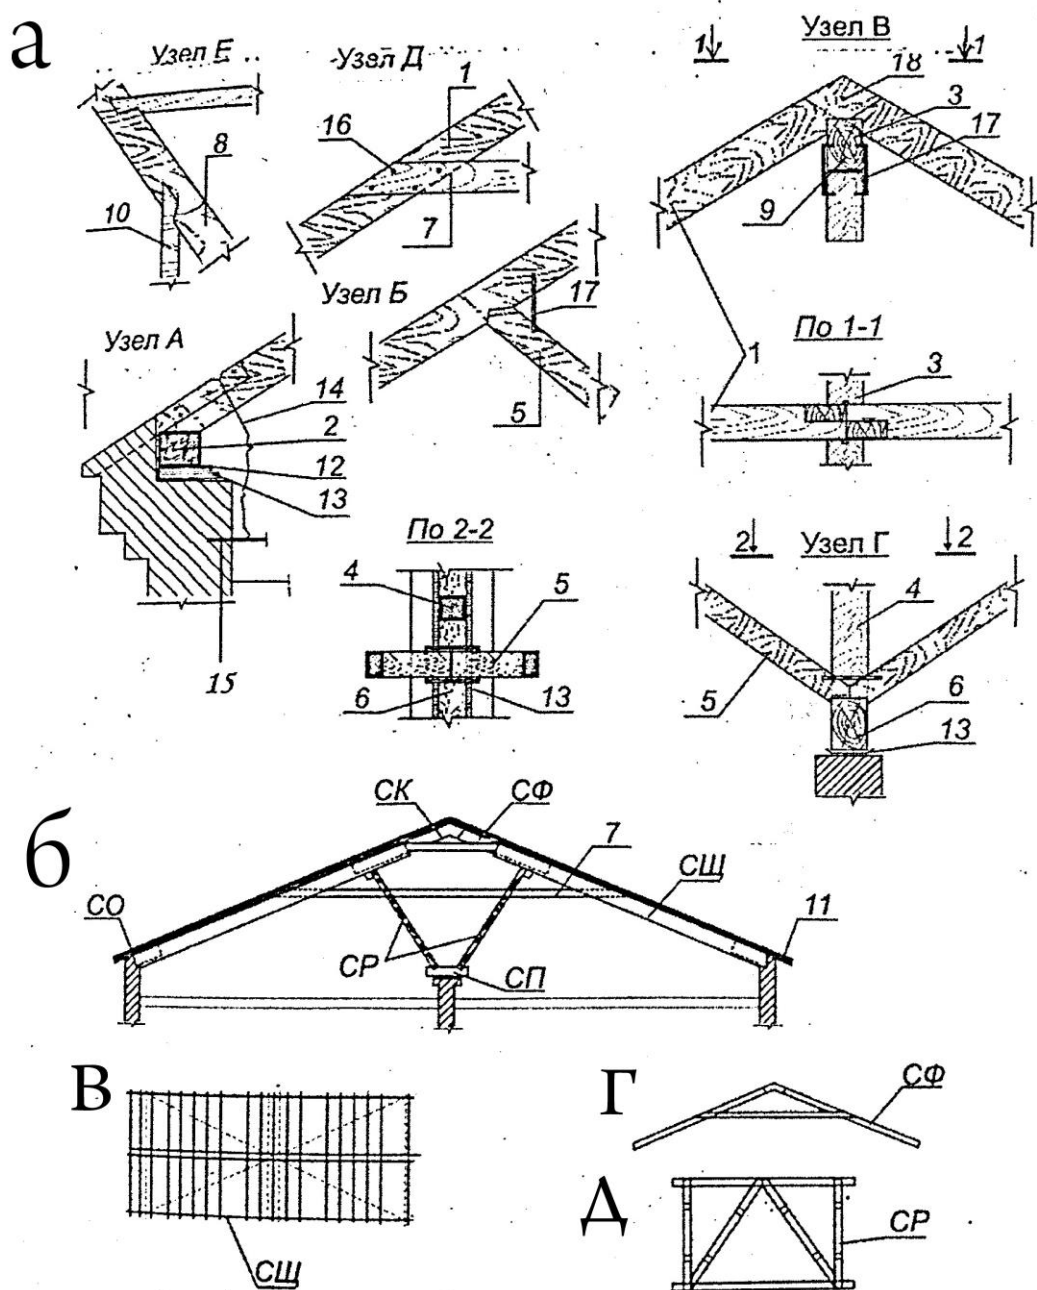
Конструкции брусчатых и сборных дощатых наслонных стропил:
